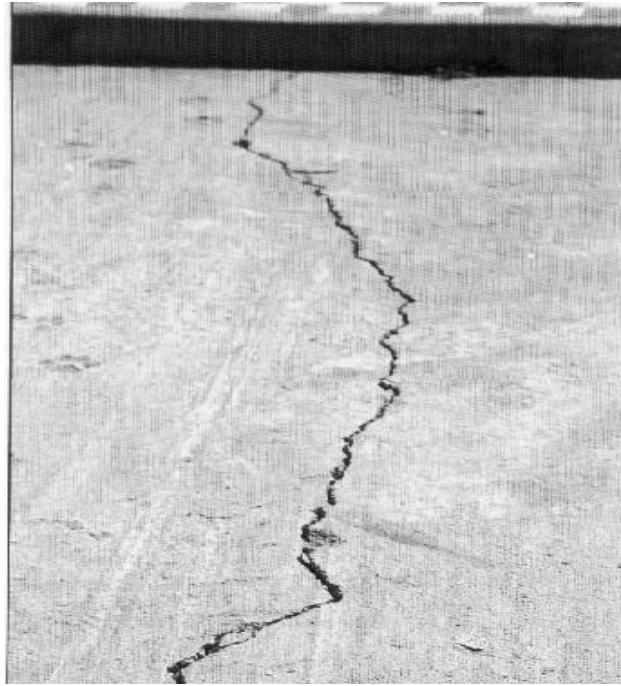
Fisura de retracción en una solera de hormigón sin armadura en su cara superior, consecuencia del fuerte soleamiento durante su fraguado y endurecimiento
